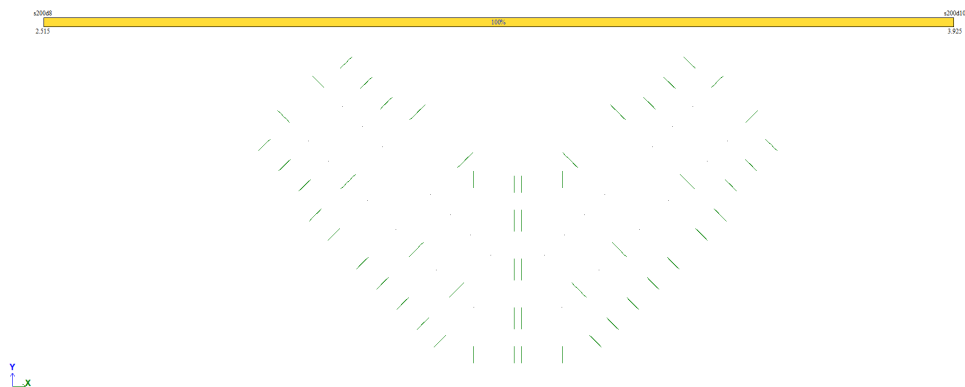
Площа арматури пілонів на 1 м. п.
